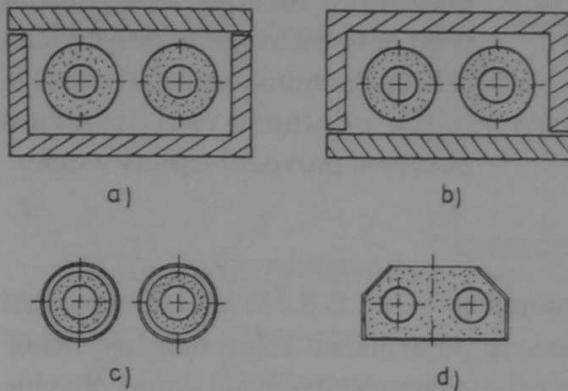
Pozemní dvoutrubková tepelná síť v zářezu (příčný řez)
